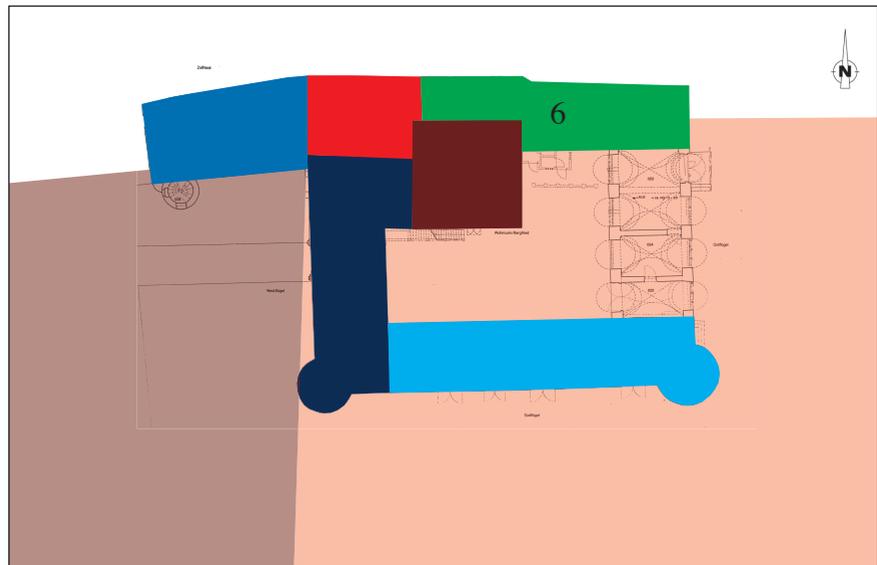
(oben) In den Grundriss der Burg ist zusätzlich der in den Jahren 1694 und 1695 (d) angefügte Nordflügel (6) eingetragen (Zeichnung: Verf.).
